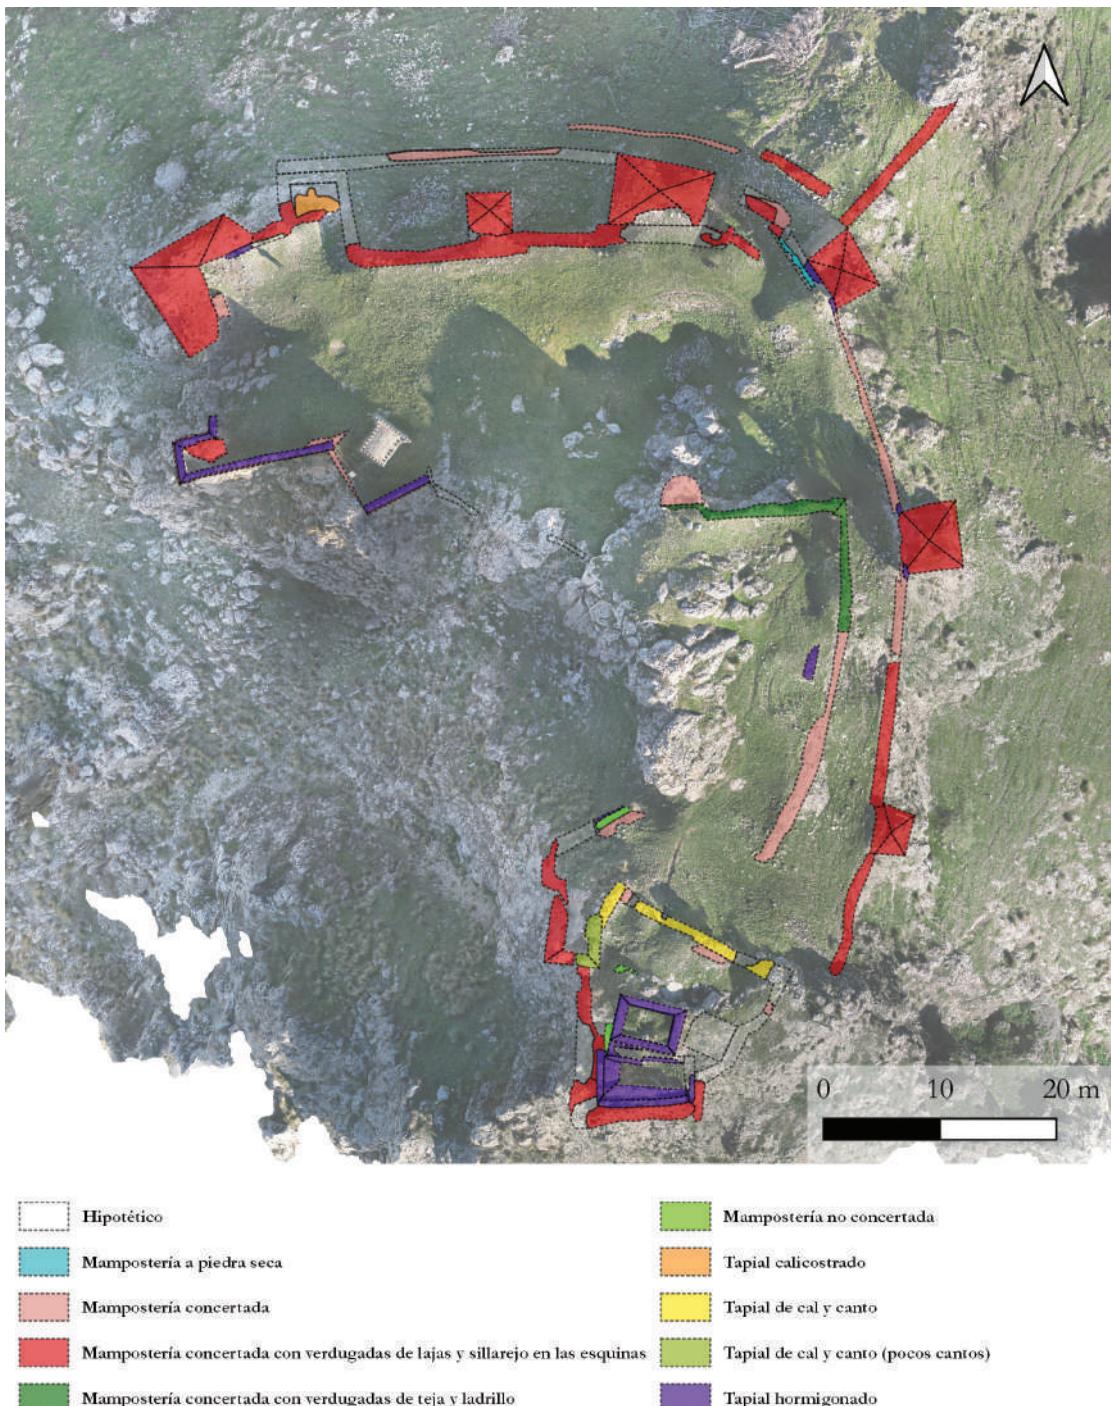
Planimetría completa del castillo de Arenas por técnicas constructivas. Fuente: los autores.
